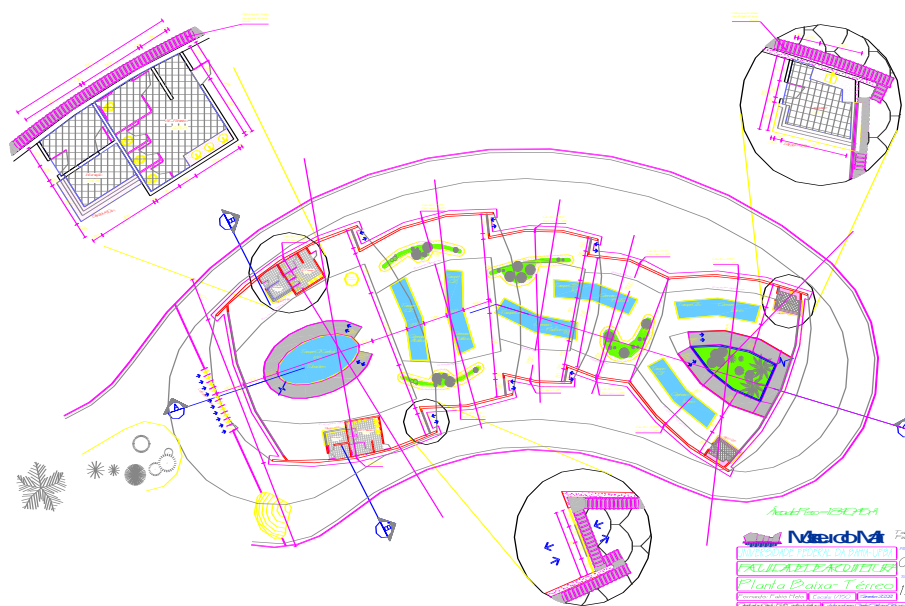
Projeto: Museu do Mar. Planta Baixa do pavimento térreo. Aluno: Fábio Melo.
